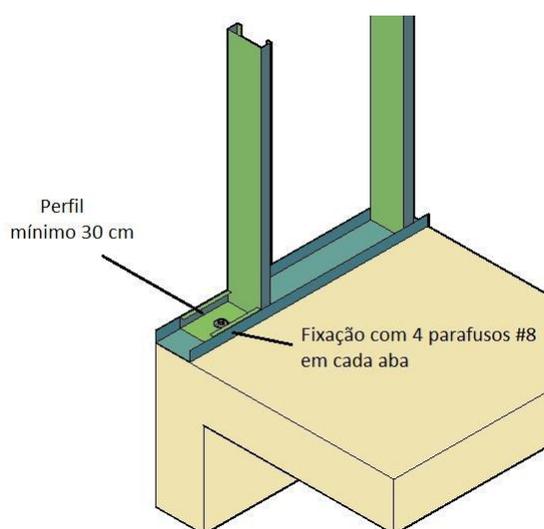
Pormenor de ligação entre parede e fundação (Silvestre et al, 2013)
